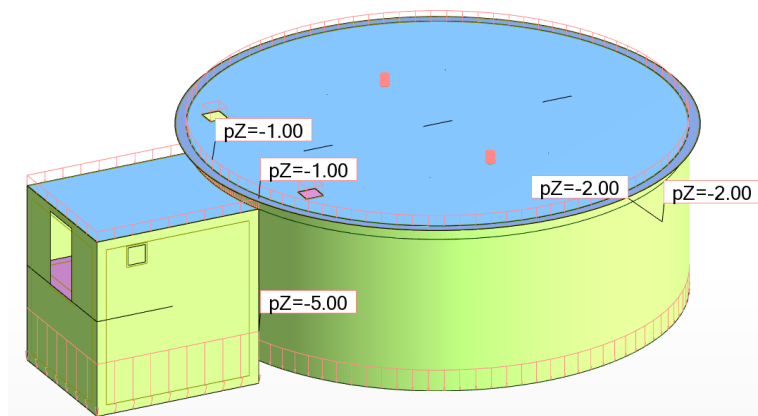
Ação das sobrecargas de pavimento e cobertura.
